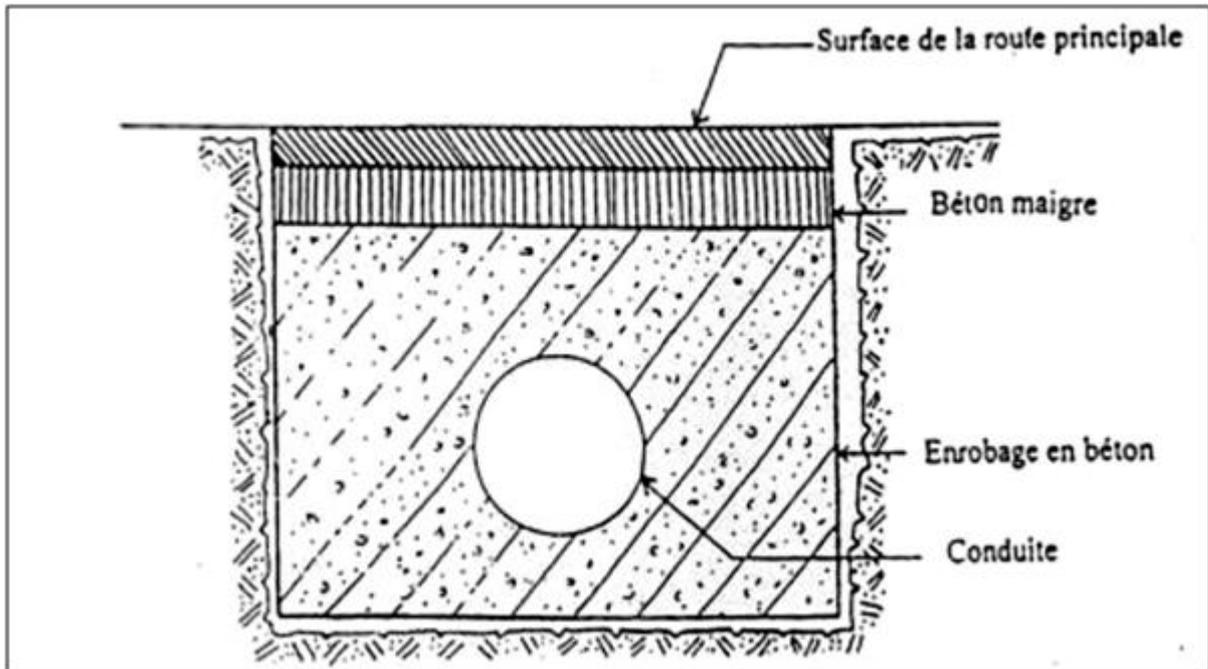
Traversée d'une route au moyen d'enrobage dans le béton.
